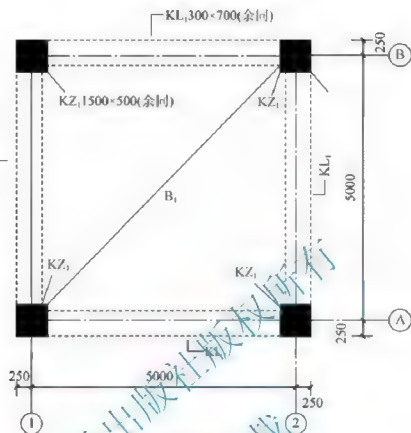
某工程现浇钢筋混凝土柱梁板结构示意图
